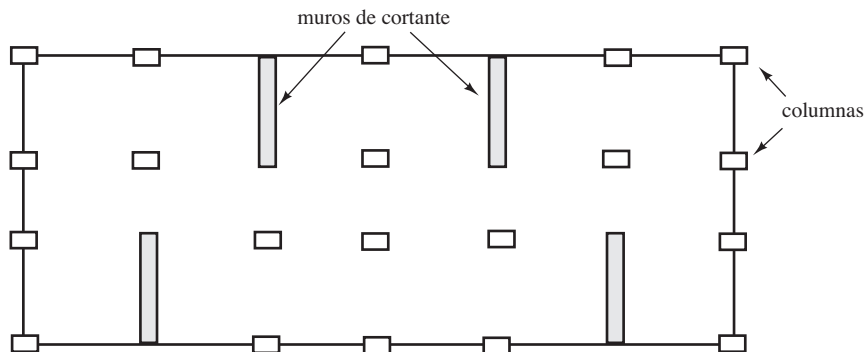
Planta de edificio que tiene muros de cortante en sólo una dirección.
